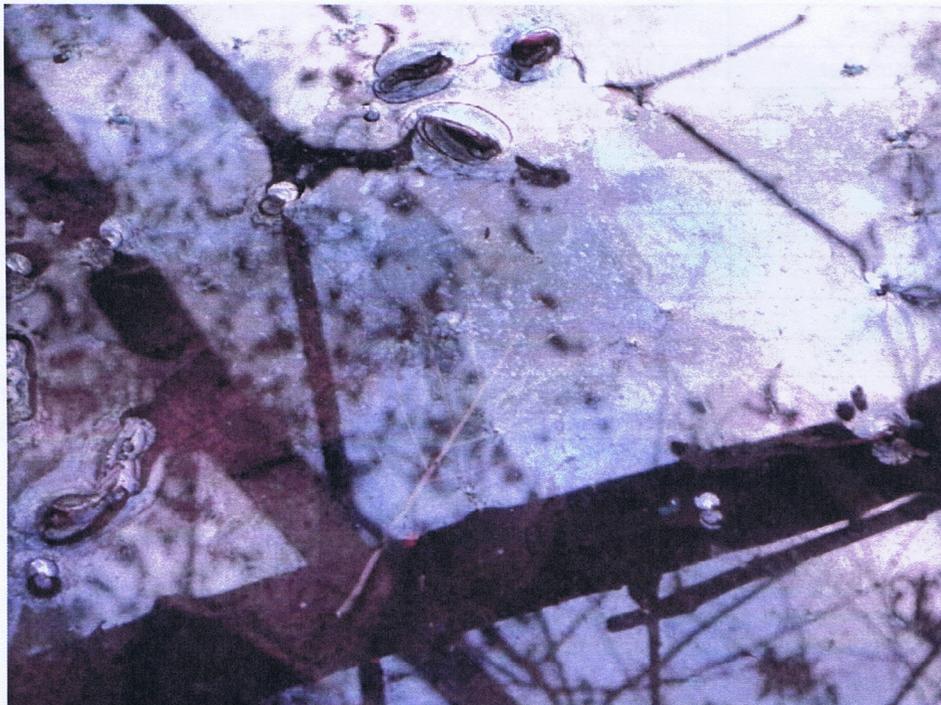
Revisions- / Übergabeschacht Regenentwässerung am Nordende des Regenrückhaltebeckens im westlichsten Grundstücksteil.
